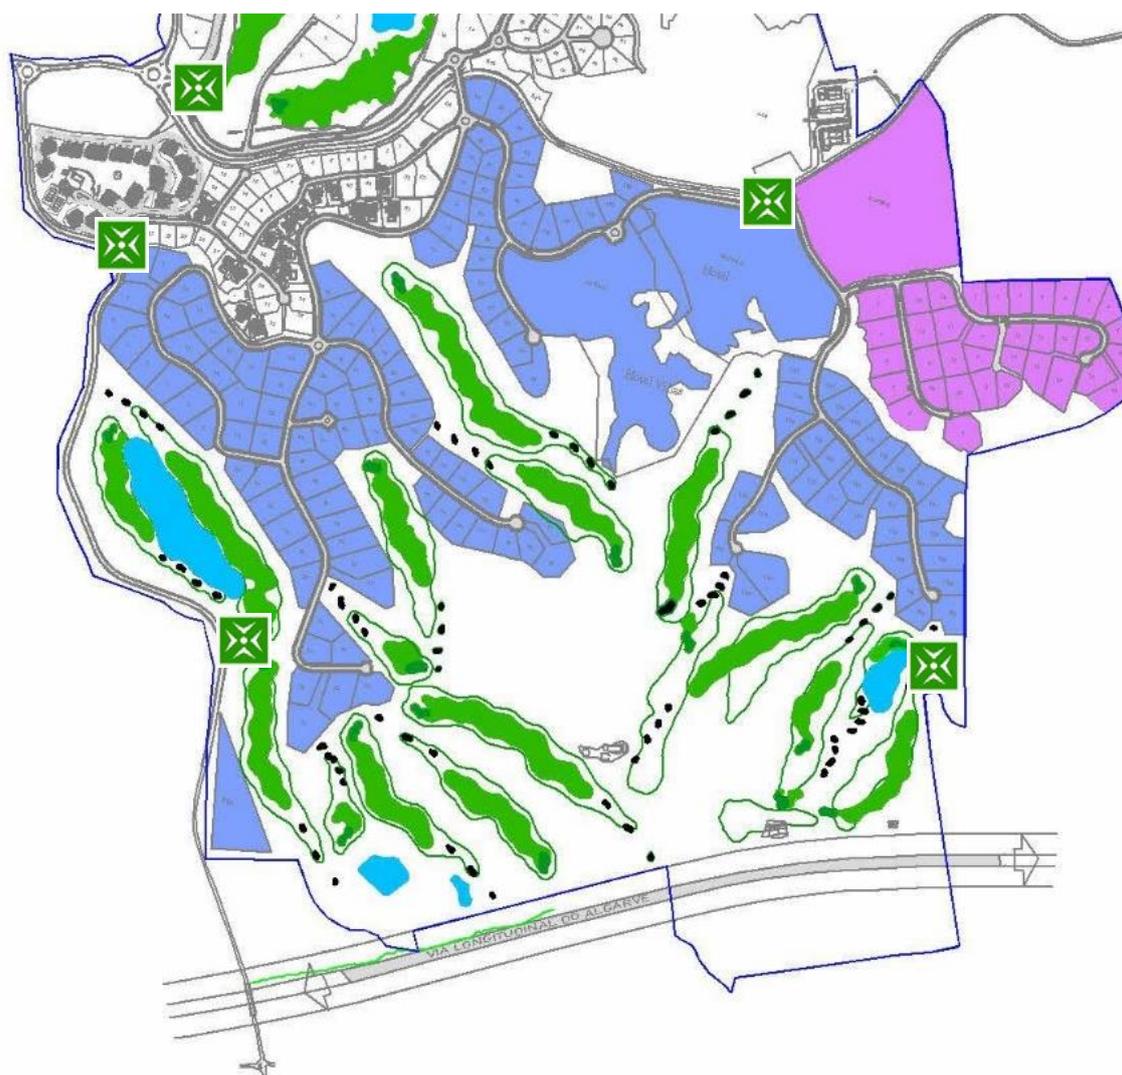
Planta de Identificação dos Pontos de Encontro da Área de Expansão Sul
